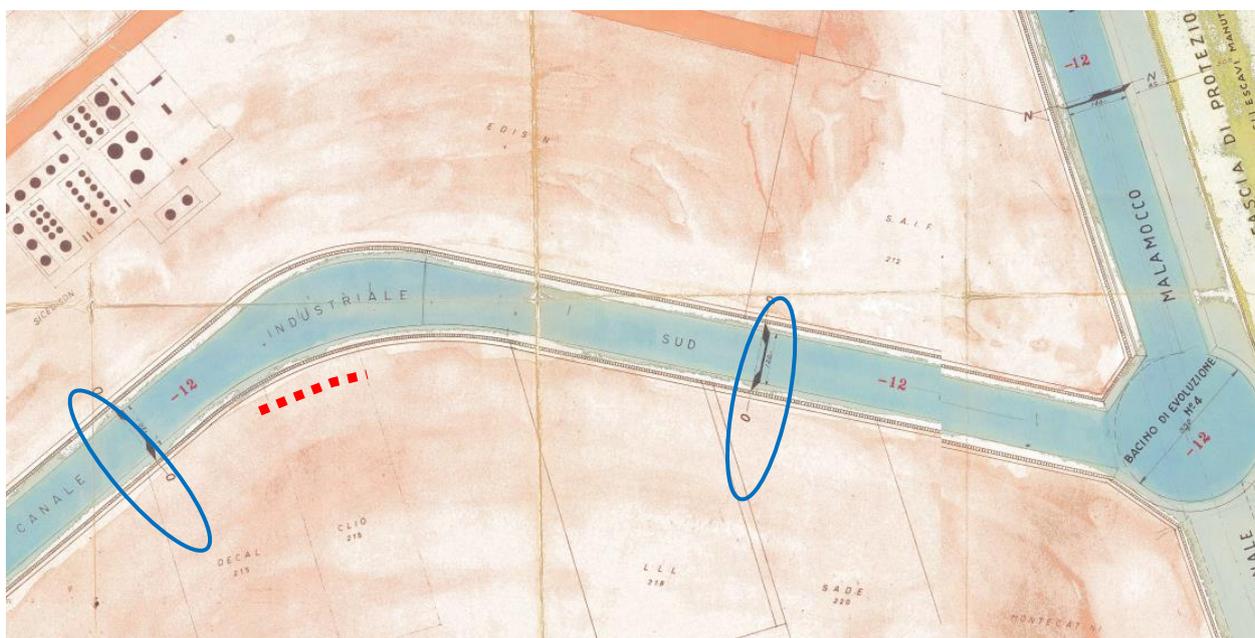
Planimetria PRP con evidenziate le Sezioni 0 – 0 del Canale Industriale Sud (blu) e indicazione della banchina oggetto di intervento (rosso)
